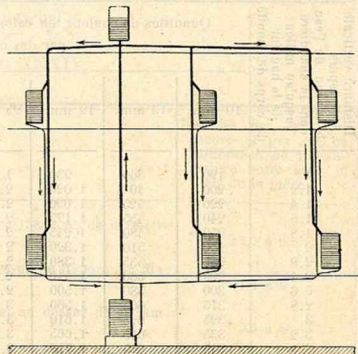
Schéma d'une installation de chauffage par eau chaude à basse pression, distribution par le haut.
